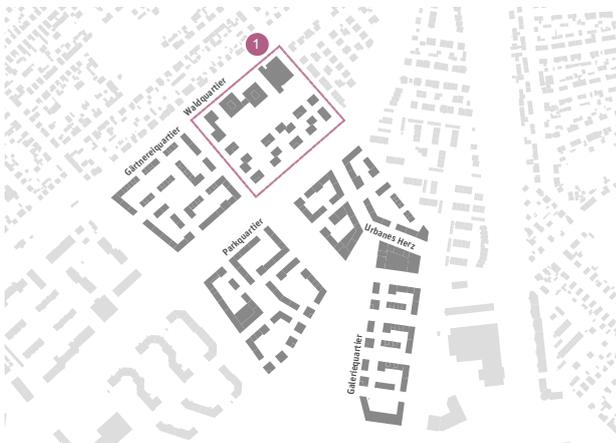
Darstellung denkbarer erster Bauabschnitt
